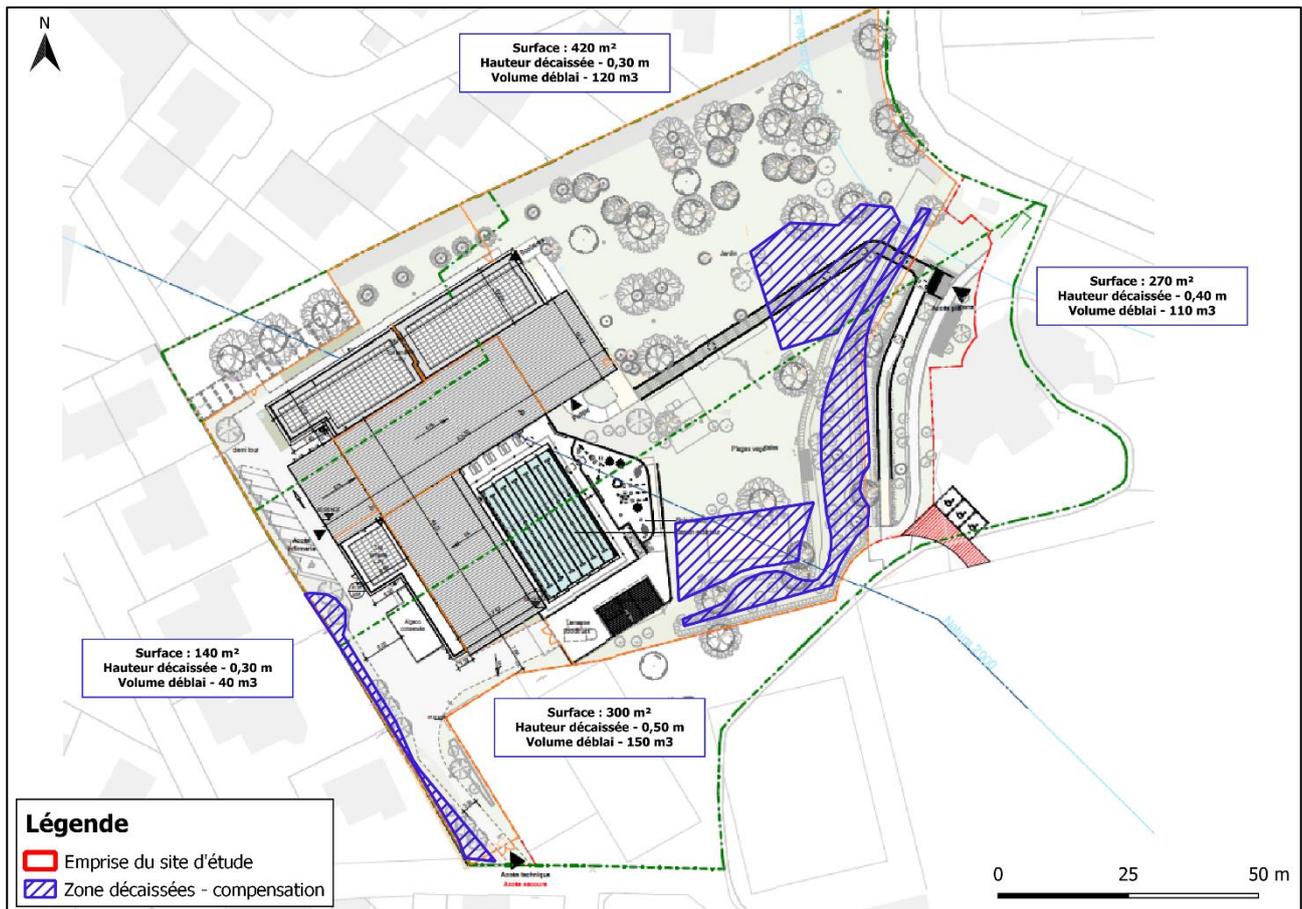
Surfaces décaissées pour compenser les remblais soustraits à la crue créés par le projet
